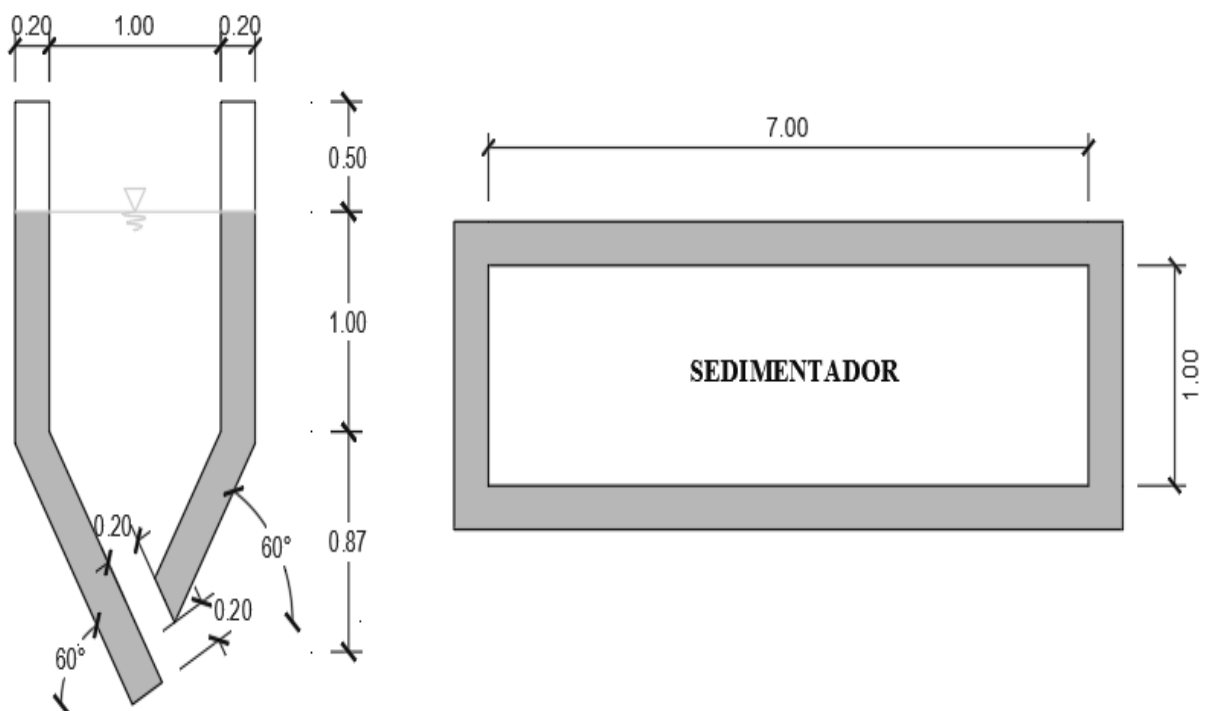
Medidas del sedimentador del tanque imhoff vista en perfil y planta
